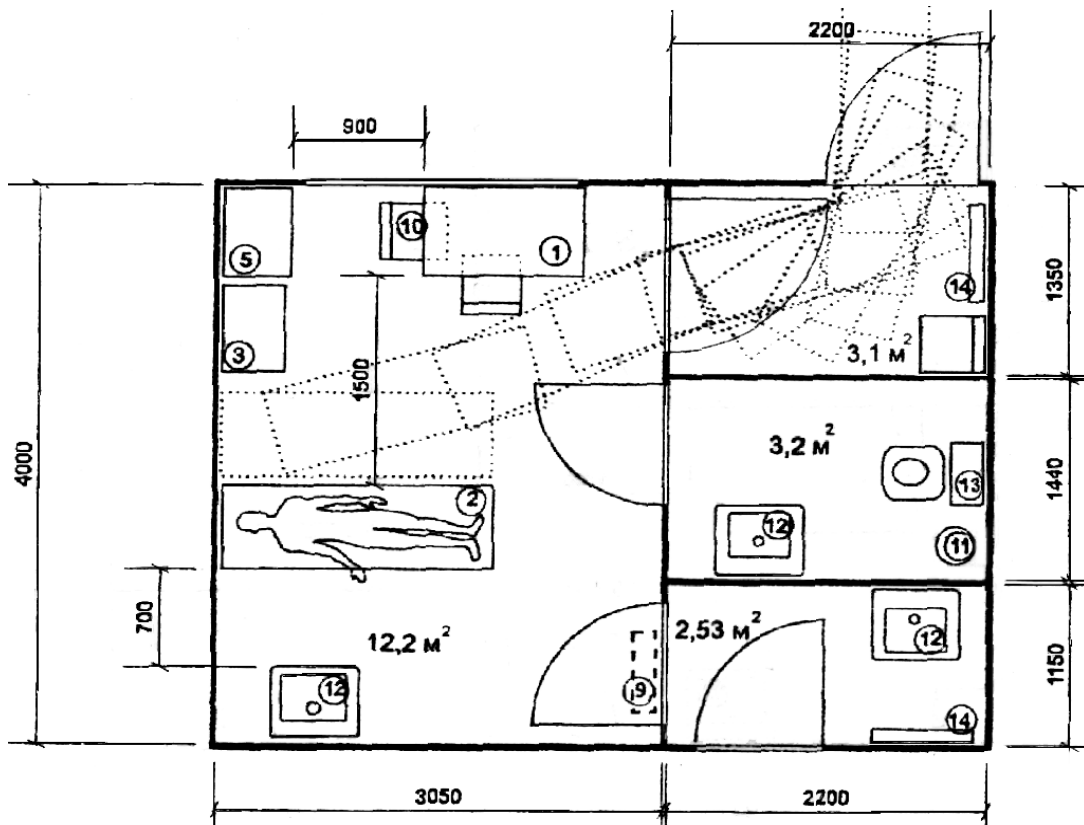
Палата для 1 больного. Даны габаритные размеры и движение каталки
